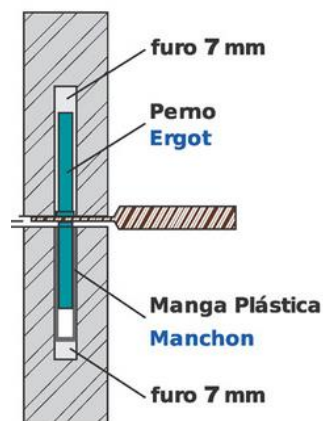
Pormenor da fixação no interior dos painéis de revestimento.
